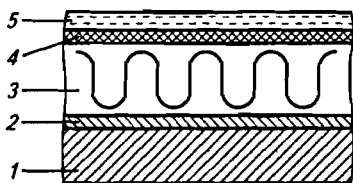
Устройство кровельного покрытия со слоем теплоизоляции из плит «Rockwool» по железобетонному основанию.
